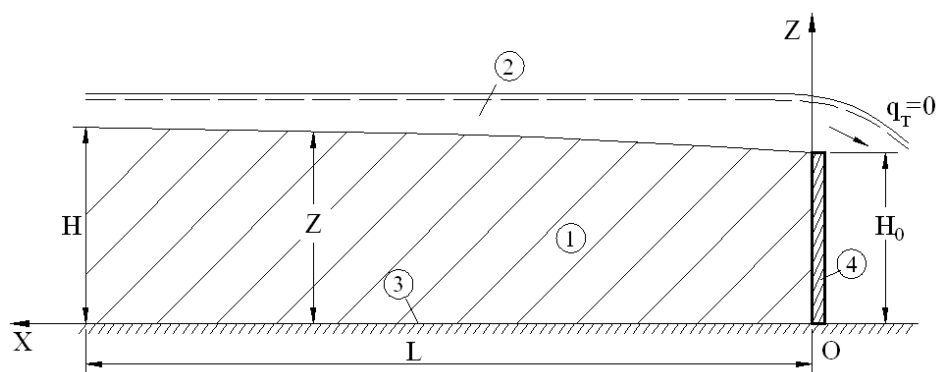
Схема устойчивого положения грунтовой среды в продольном разрезе:
